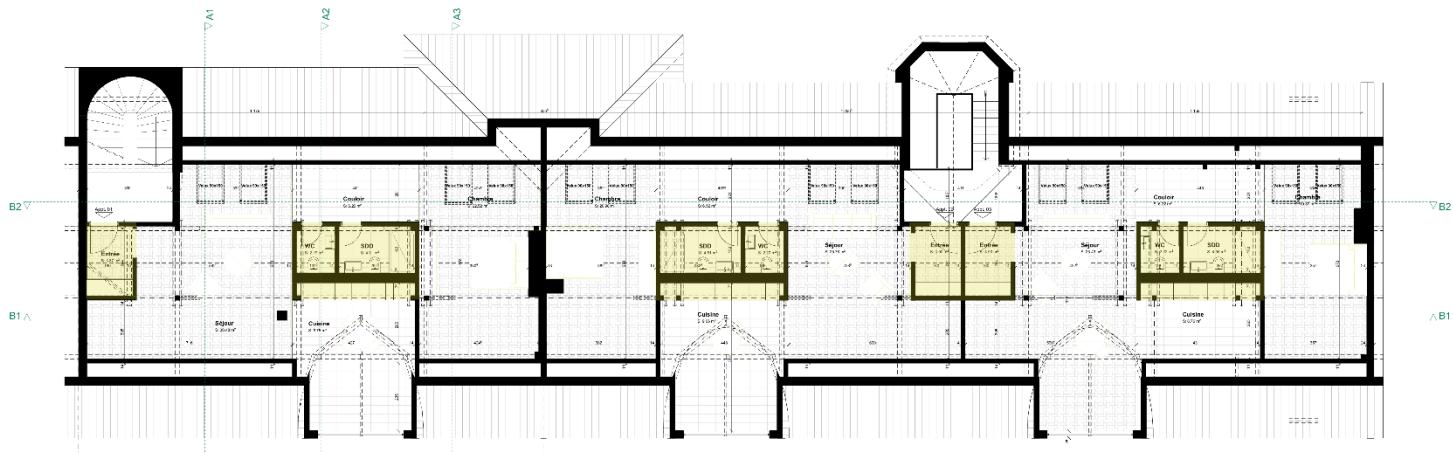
Bâtiment Mon-Loisir 11, 13 – Plan Combles – Proposition de transformation
